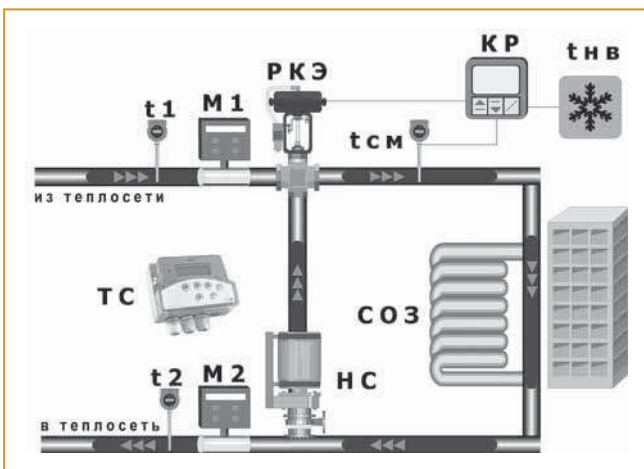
Схема теплового узла здания с САР теплоснабжения
